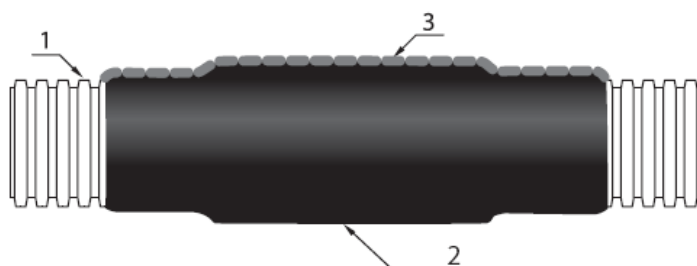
Ремонт трубопровода «РУВИНИЛ» с кабелями при локальном повреждении: 1 – трубопровод с локальным повреждением 3, 2 – термоусаживаемая манжета с подклеивающим подслоем.
